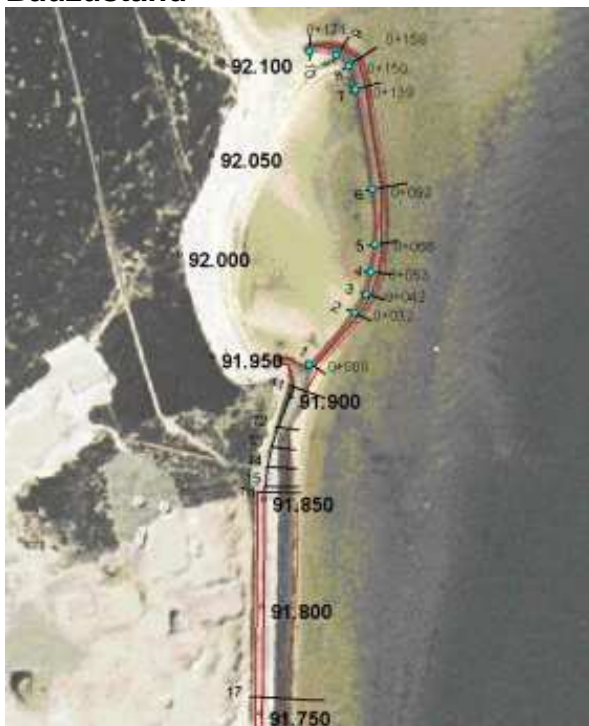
Lageplan Schutzmole Budersand LKN-SH
